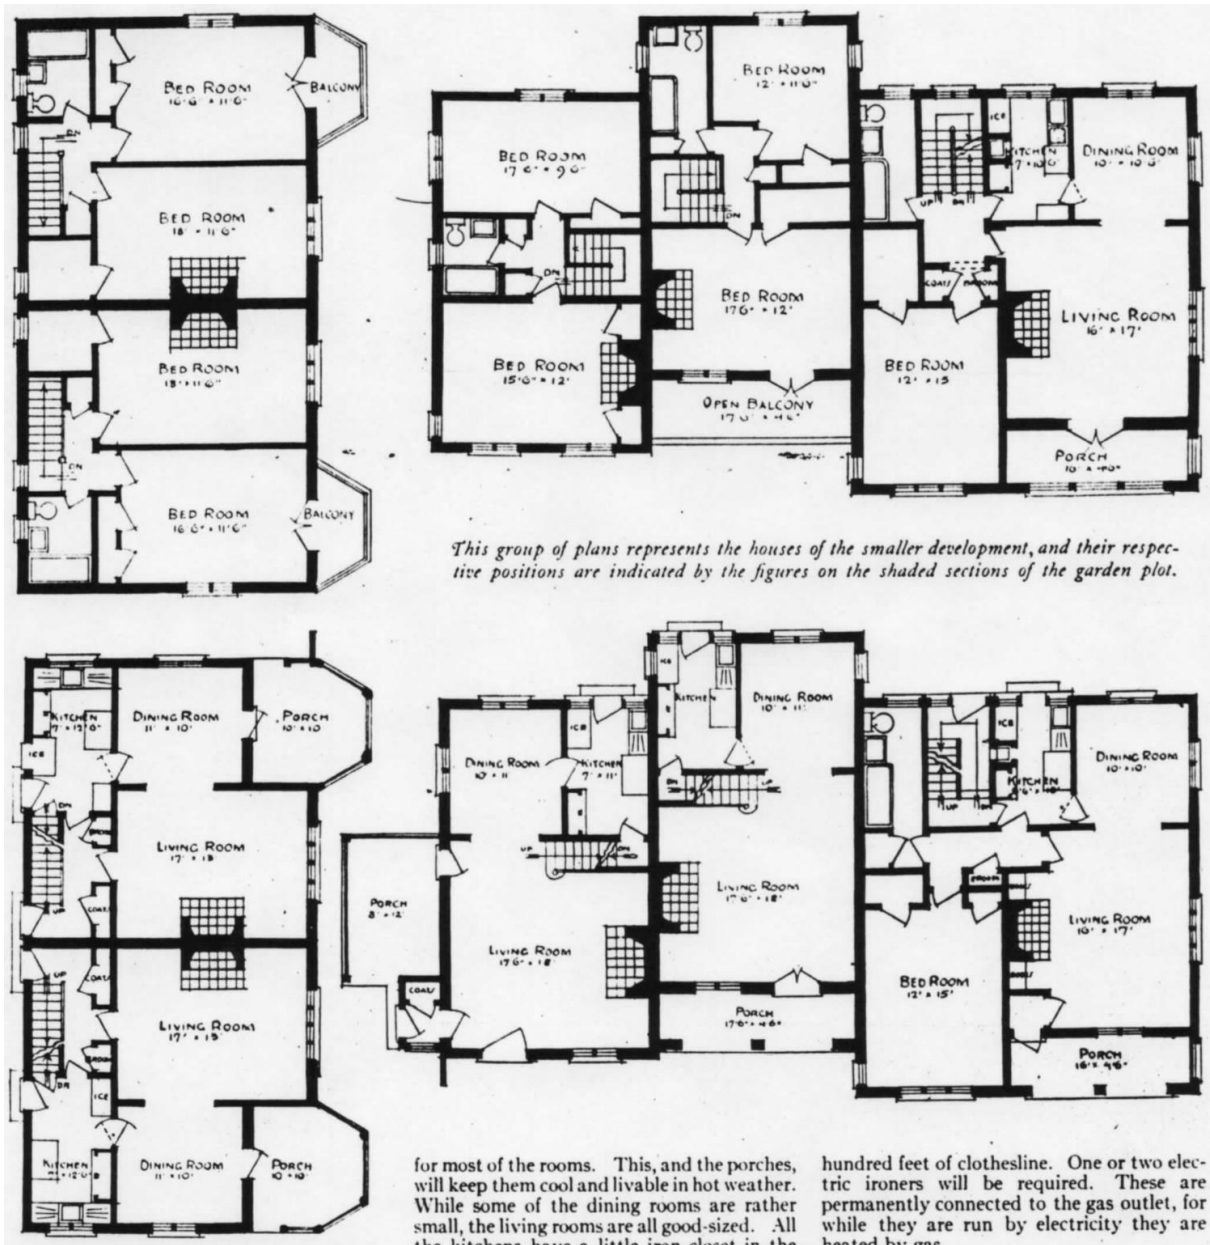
Wohnhausgruppe, Geschossgrundrisse, um 1923.
